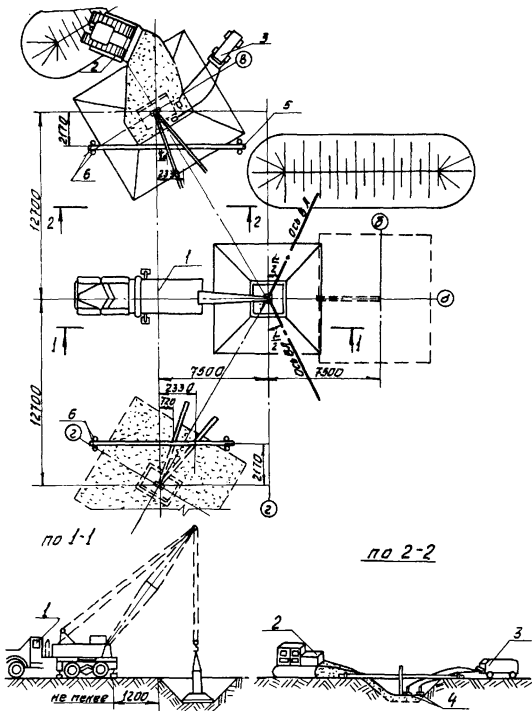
Установка элементов фундаментов опоры УСБ 110-1 с обратной засыпкой котлована
